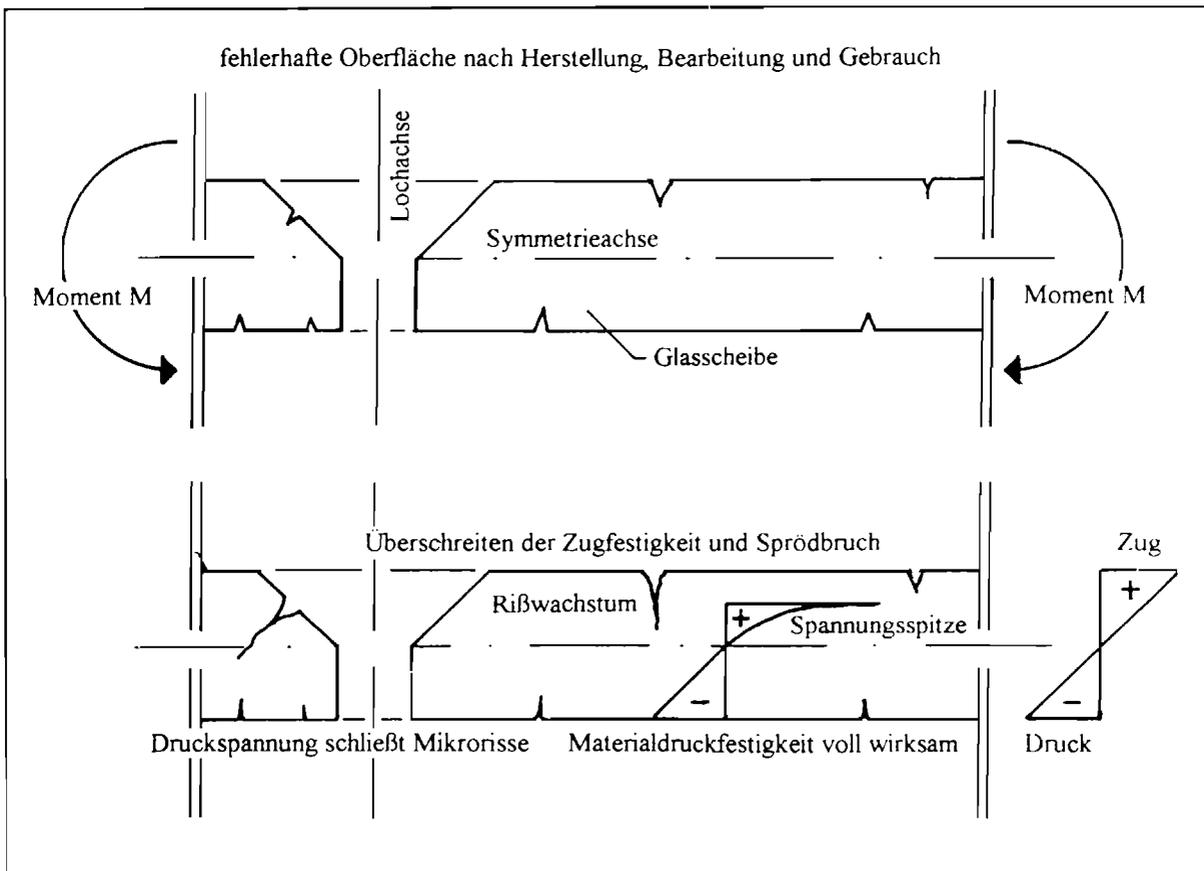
Versagensmechanismus einer biegebeanspruchten Glasscheibe
